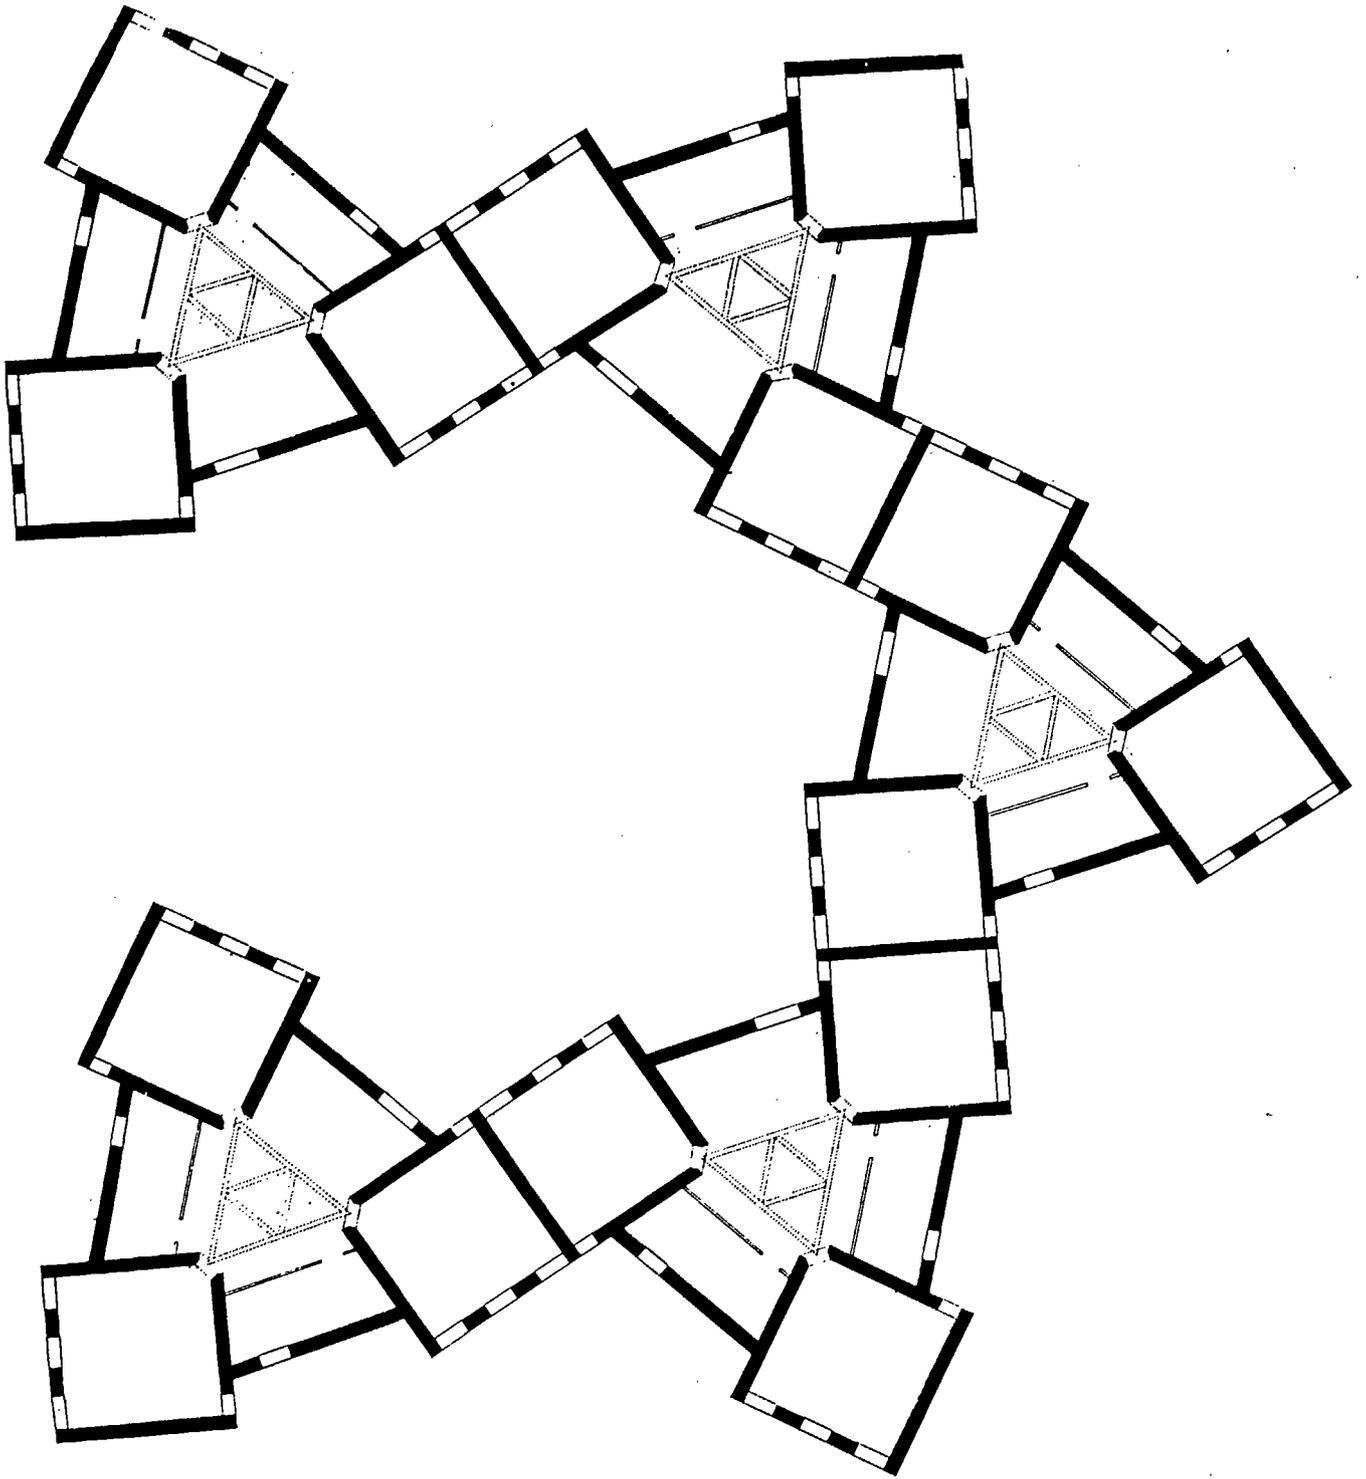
Niğde - Ecole rurale - Possibilités d'extension du plan.
